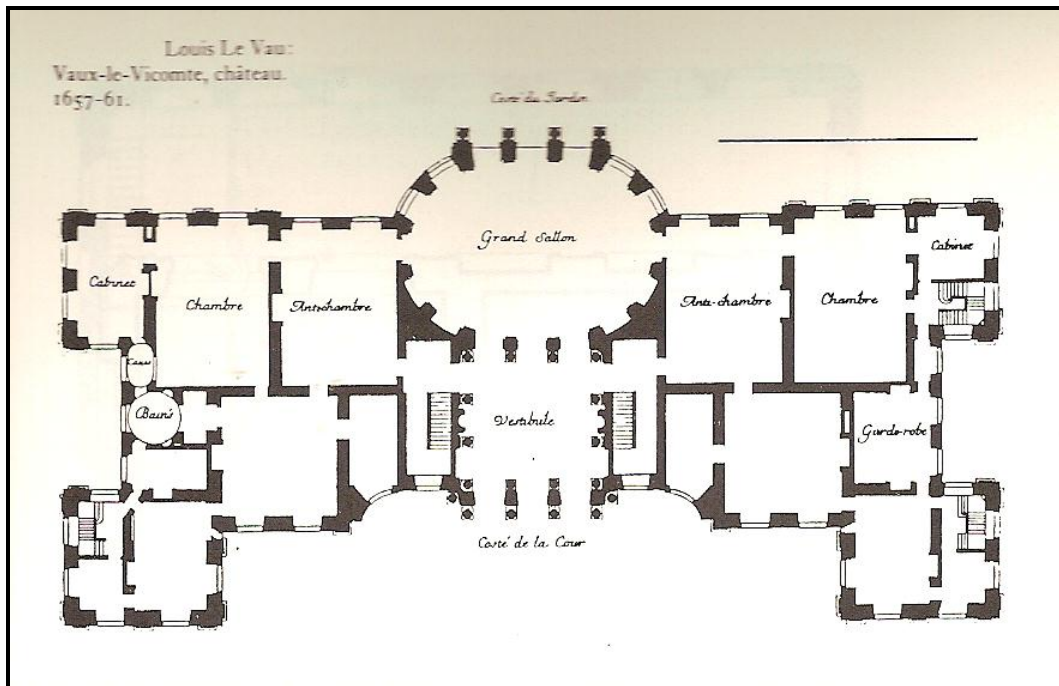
Louis Le Vau, Vaux-le-Vicomte, Grundriss Erdgeschoss
